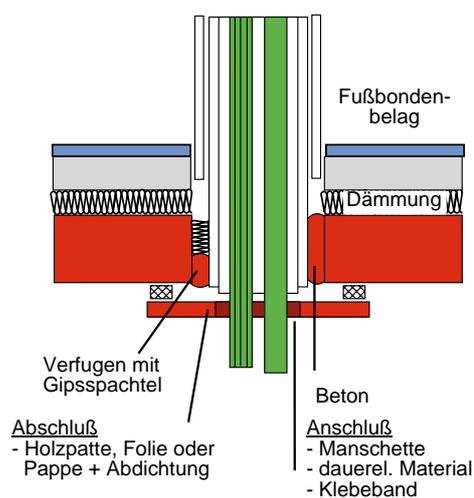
Abschluss eines Installationsschachts an einen Massivboden.
